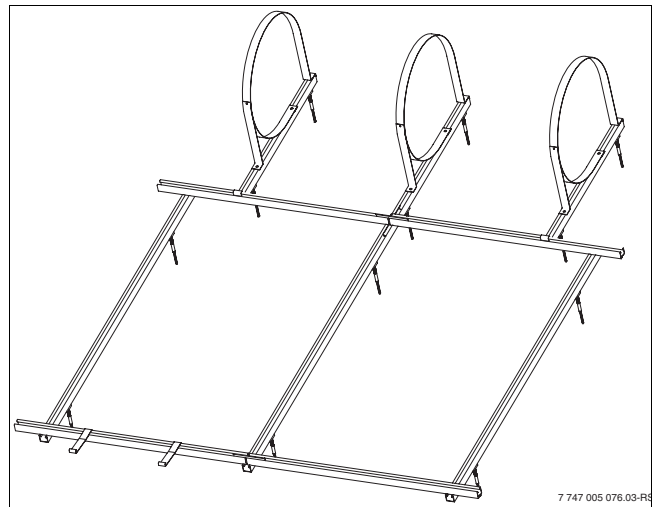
Vista de conjunto del soporte para tejado inclinado (sistema de 300 l)
